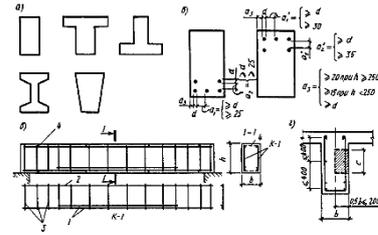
Формы поперечного сечения и армирование железобетонных балок: а — возможные формы сечений; б — размещение продольной арматуры в сечении; в — армирование односторонней железобетонной балки; г — определение площади дополнительной арматуры у боковой грани балки при l > 700 мм; 1 — рабочая арматура; 2 — монтажная арматура; 3 — поперечная арматура; 4 — соединительная арматура
